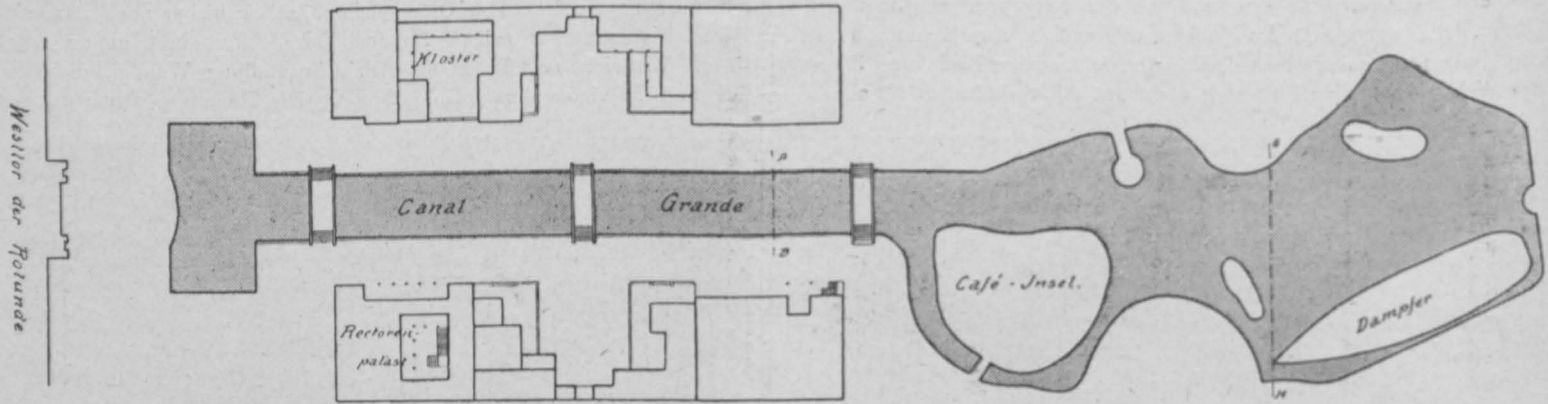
Lageplan des „Meeres“ der Adria-Ausstellung.
